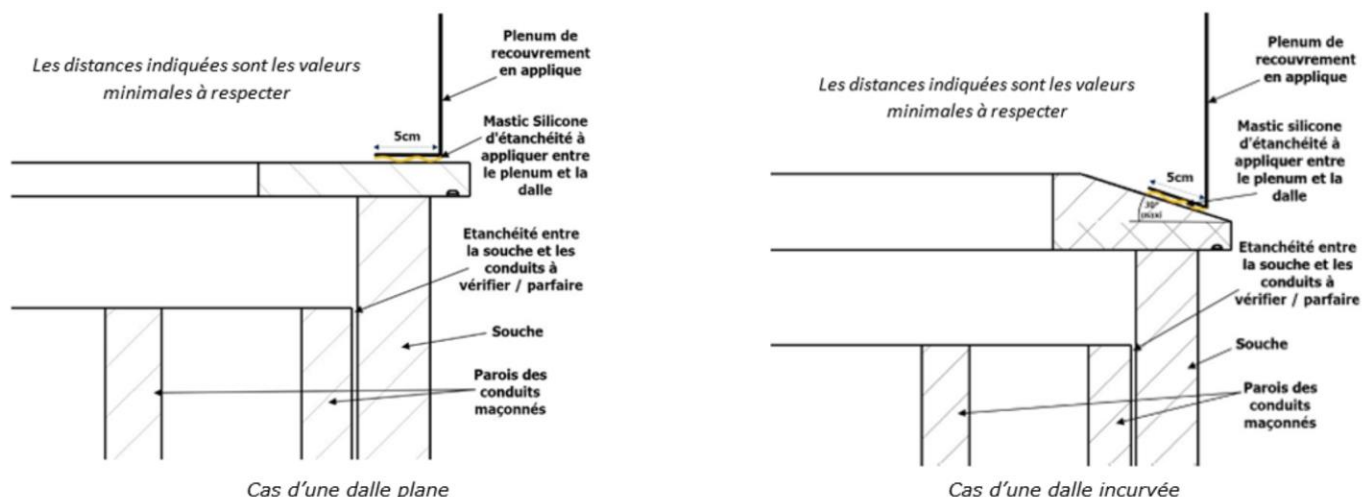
Coupes verticales d'un plenum de recouvrement en applique sur dalle conservée
